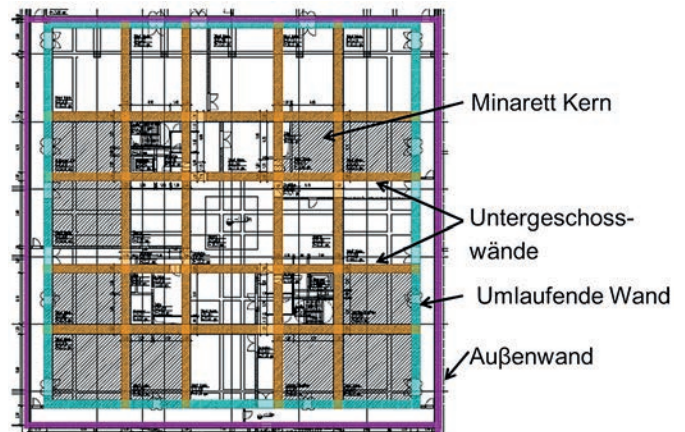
Die Stahlbetonwände der Untergeschosse (Grundriss)
